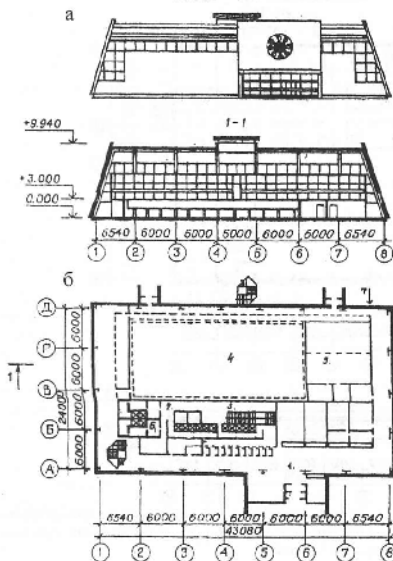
Плавательный бассейн в легких металлических конструкциях: а - фасад; б - план: 1 - вестибюль; 2,3 - раздевалные и душевые; 4 - ванна для плавания; 5 - залы подготовительных занятий; 6 - сауны
